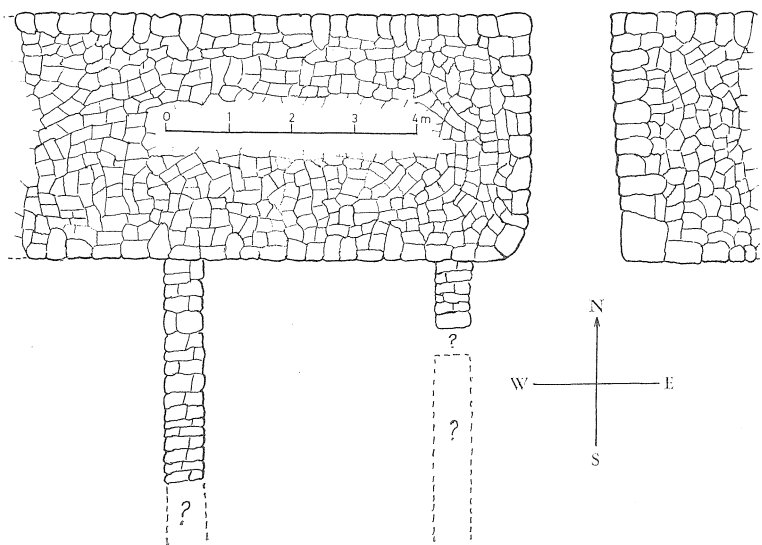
Porta do lado norte e resto de casa arrimada à muralha, cuja face interna substitui a parede da casa daquele lado.
